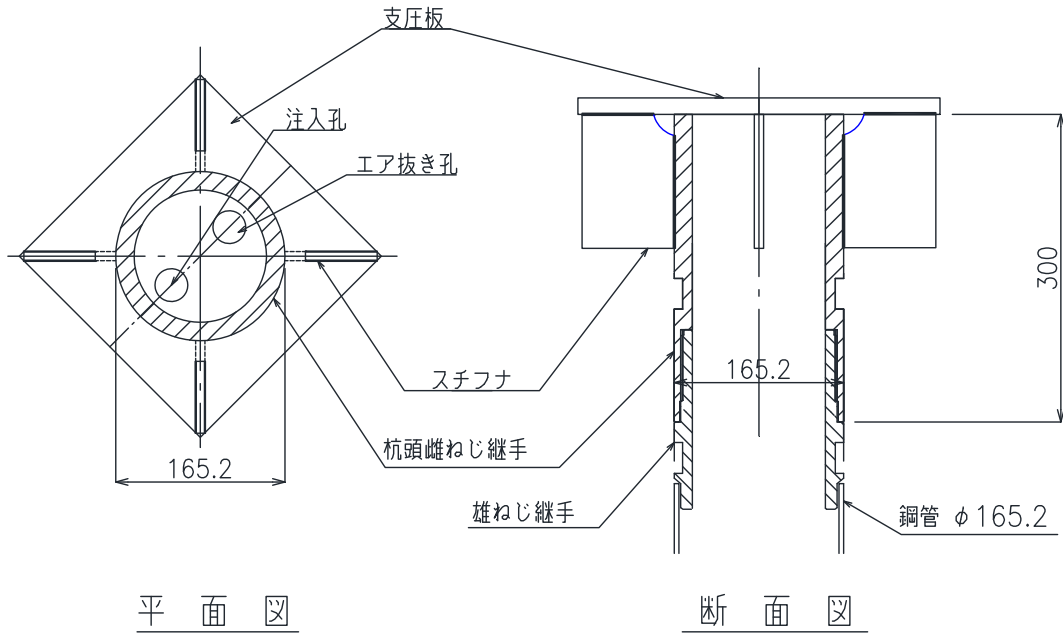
杭頭部の構造（例：φ165.2mm用）
